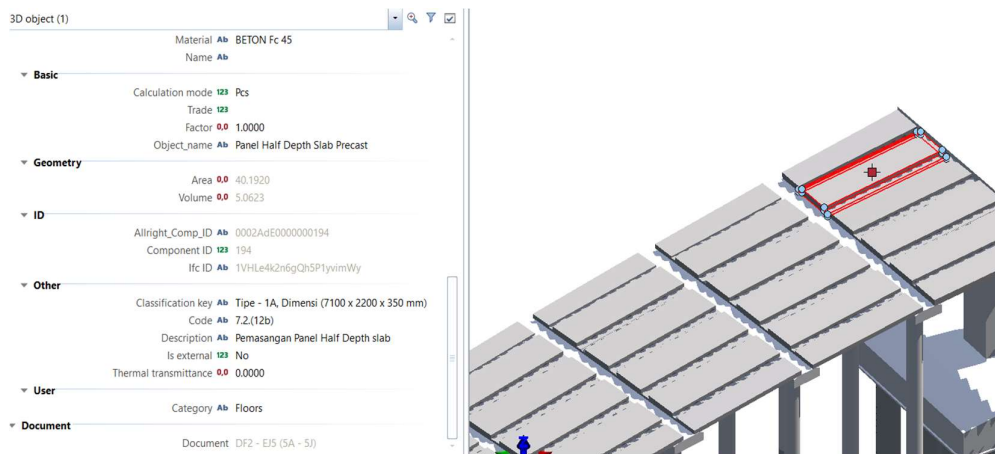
Quantity Take Off Beton Half Slab Precast Tipe 2C
